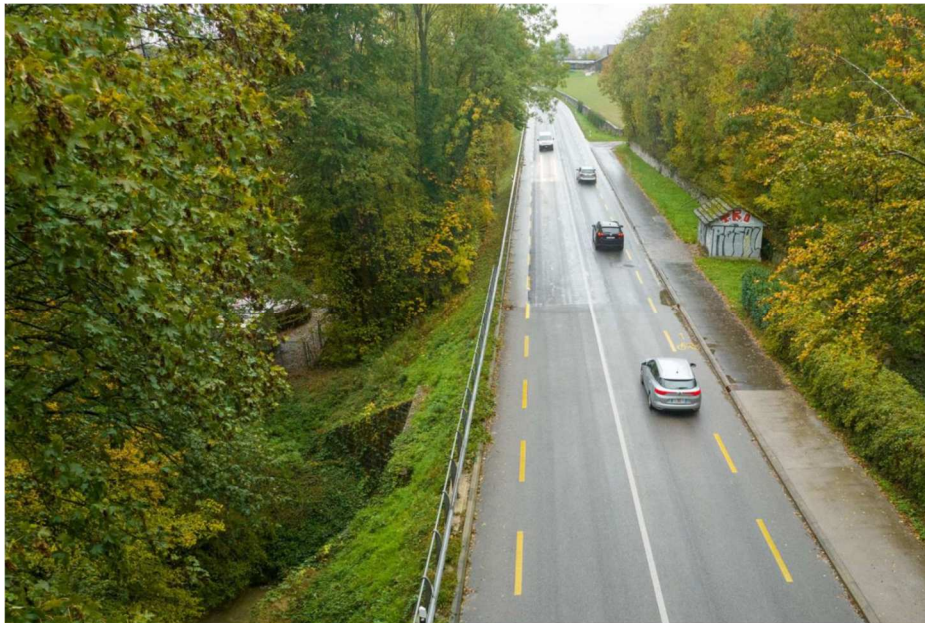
Chaussée actuelle dans le prolongement du pont sur la Dullive direction Genève,
